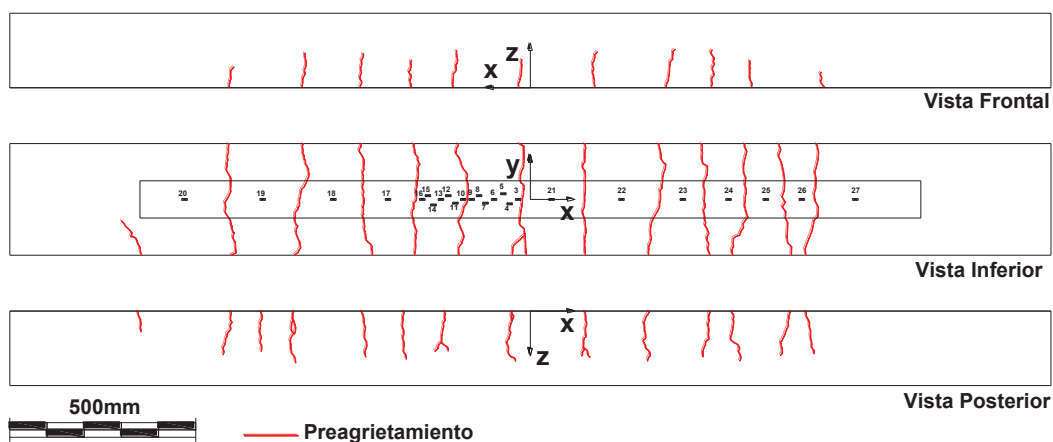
Esquema del patrón de agrietamiento de viga 2A.
